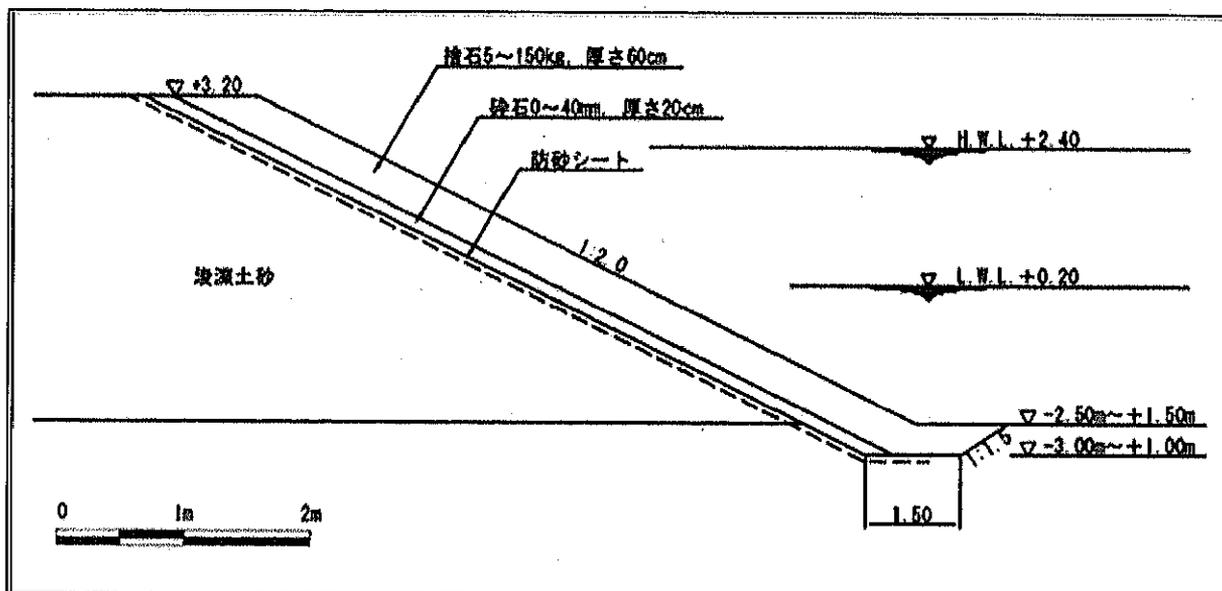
(18-2) 護岸の標準断面図 (護岸B:埠頭西側端部)
